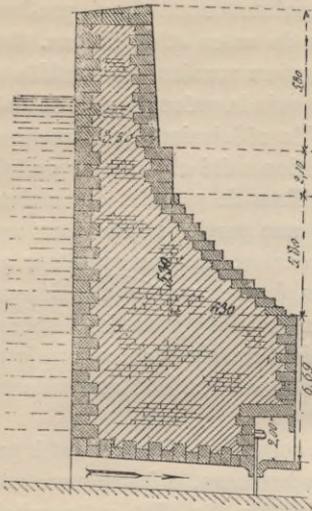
et 20. — Coupe et plan du barrage d'Almanza.
